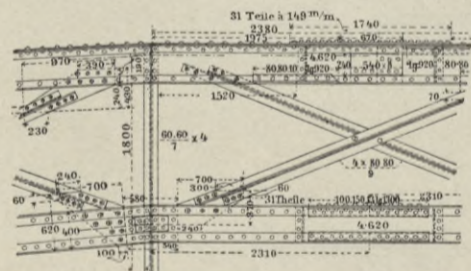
Ansicht des Hauptträgers in der Mitte. 1 : 80.
